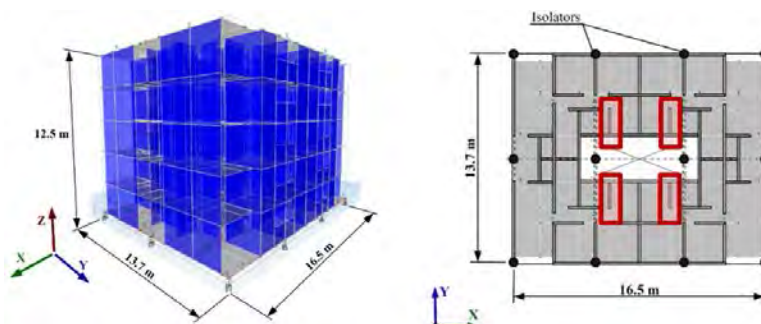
Estructura de referencia: a) Isometría estructural; b) Planta estructural
